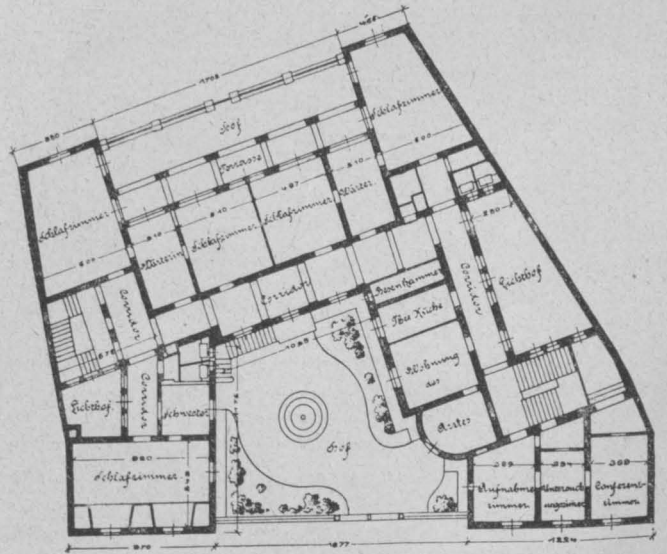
Kinderasyl in der Kürassierstraße. Grundriss des Obergeschosses.
